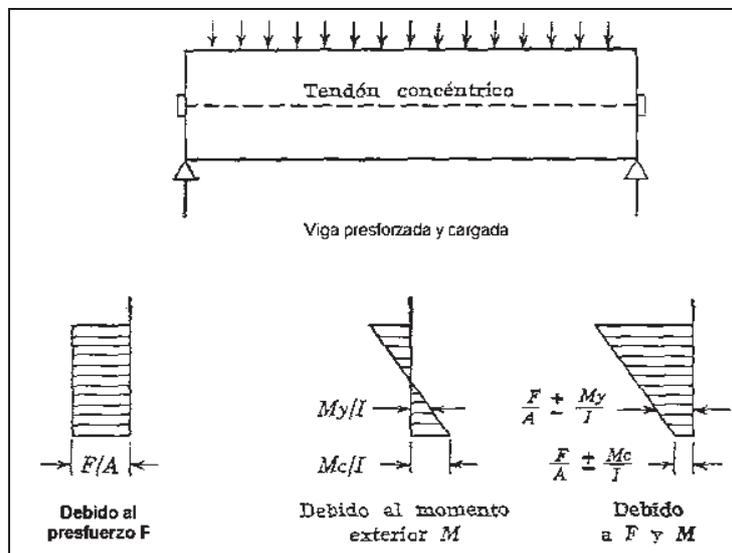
Distribución del esfuerzo a través de una sección de concreto presforzado concéntricamente [2].
